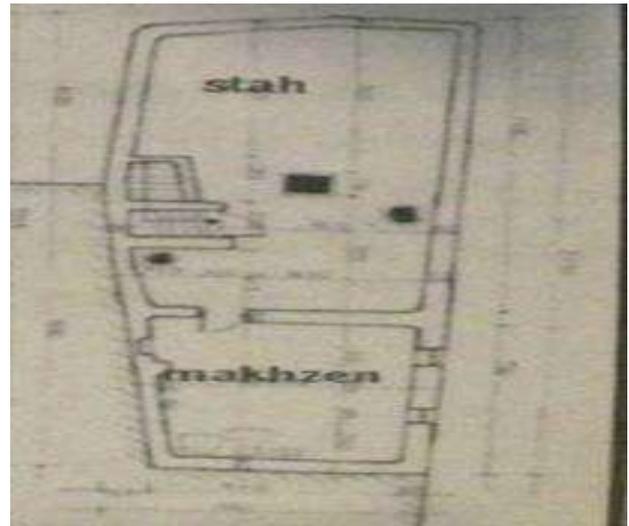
Une maison traditionnelle libanaise, plan de l'étage
